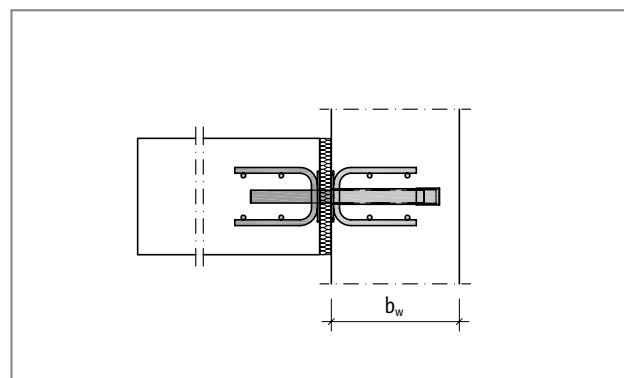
Schöck Dorn Typ SLD: Minimale Bauteildicke einer Wand oder Stütze
